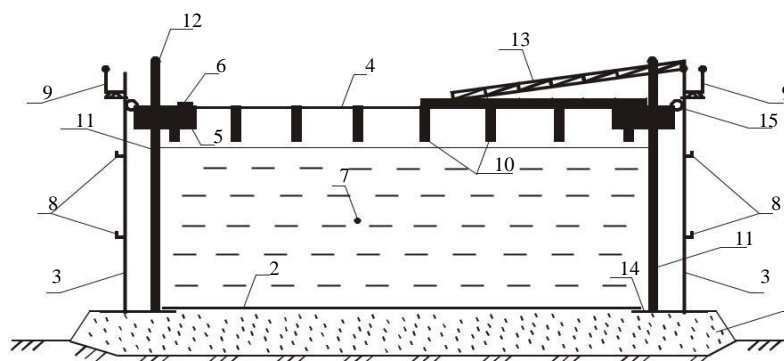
Конструкція резервуара з плаваючою дахом:
